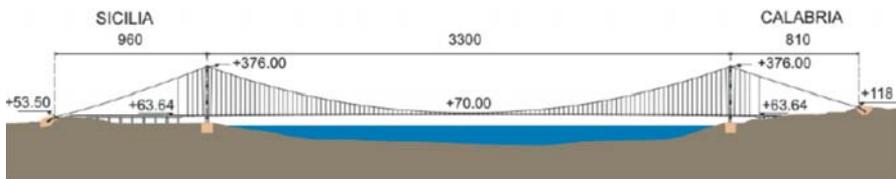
Sezione longitudinale del Ponte sullo Stretto di Messina
